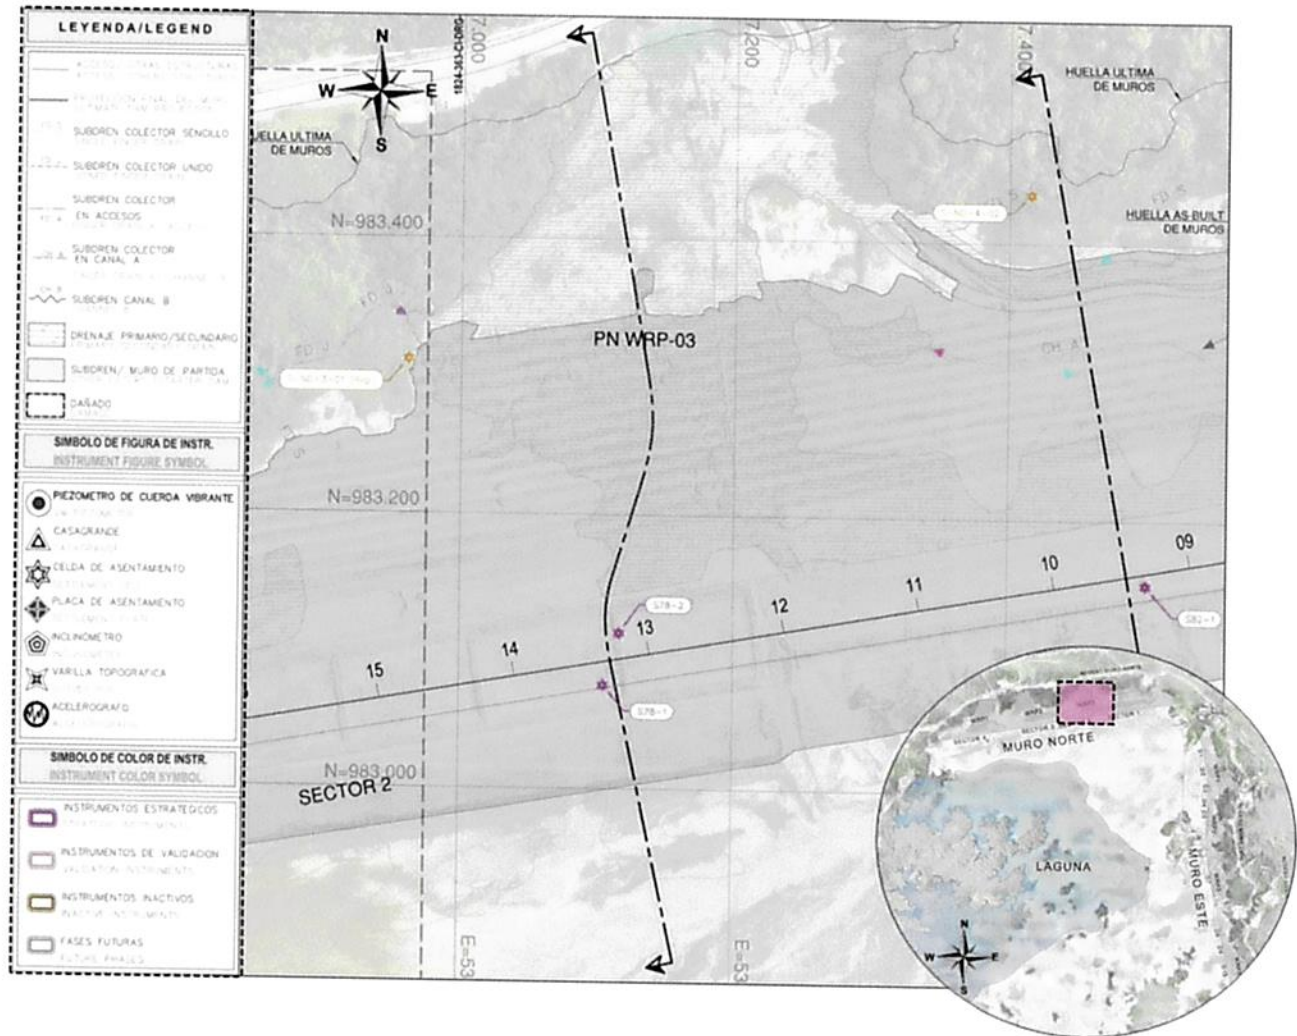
Vista de Planta en el Sector 1 - WRP3 con las Celdas de Asentamiento
